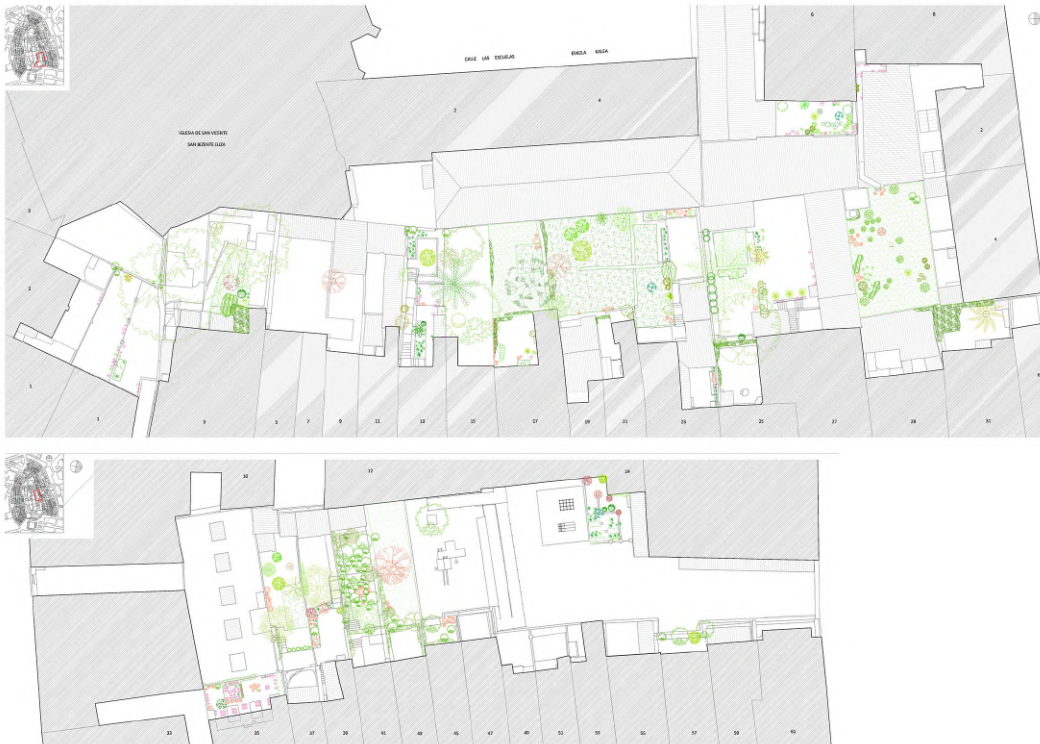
/ Planos de plantación de las manzanas de transición M1 y M2
